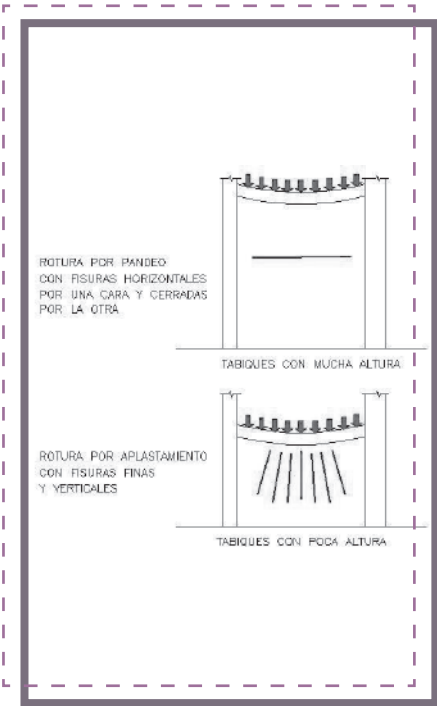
Esquema de las fisuras en viga de hormigón armado por excesiva flecha.
